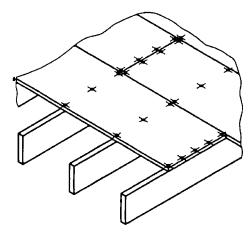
Конструкційне монтування крайок з гребенем та пазом, що укладають поперек короткими крайками, утримуваними на балках
